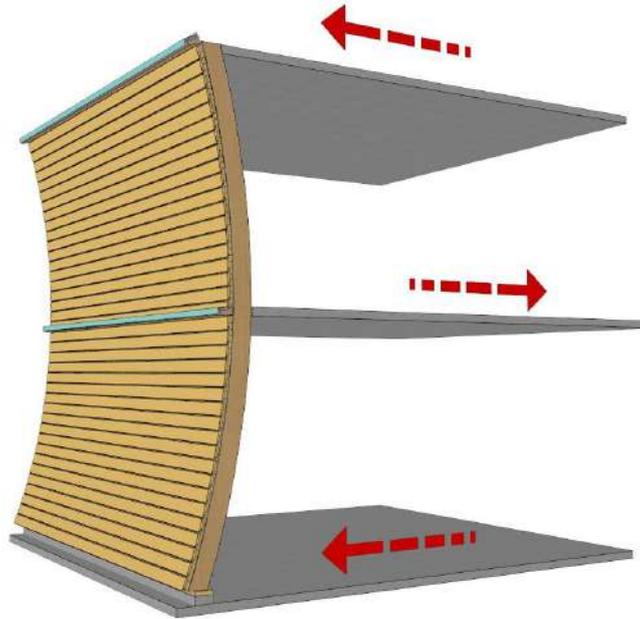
Illustration de la mise en flexion 3 points d'une façade filante
